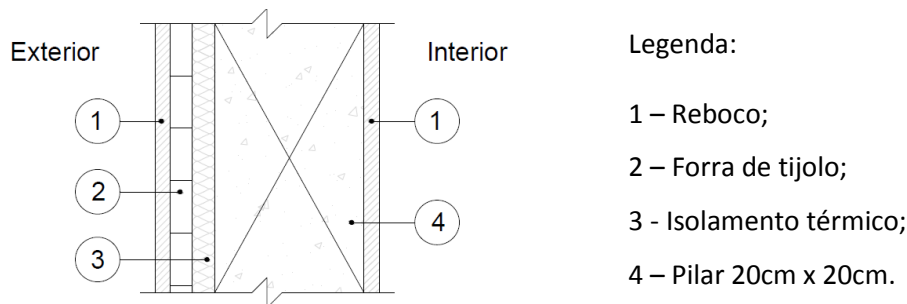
PTP_{pilar} localizado na parede exterior.
